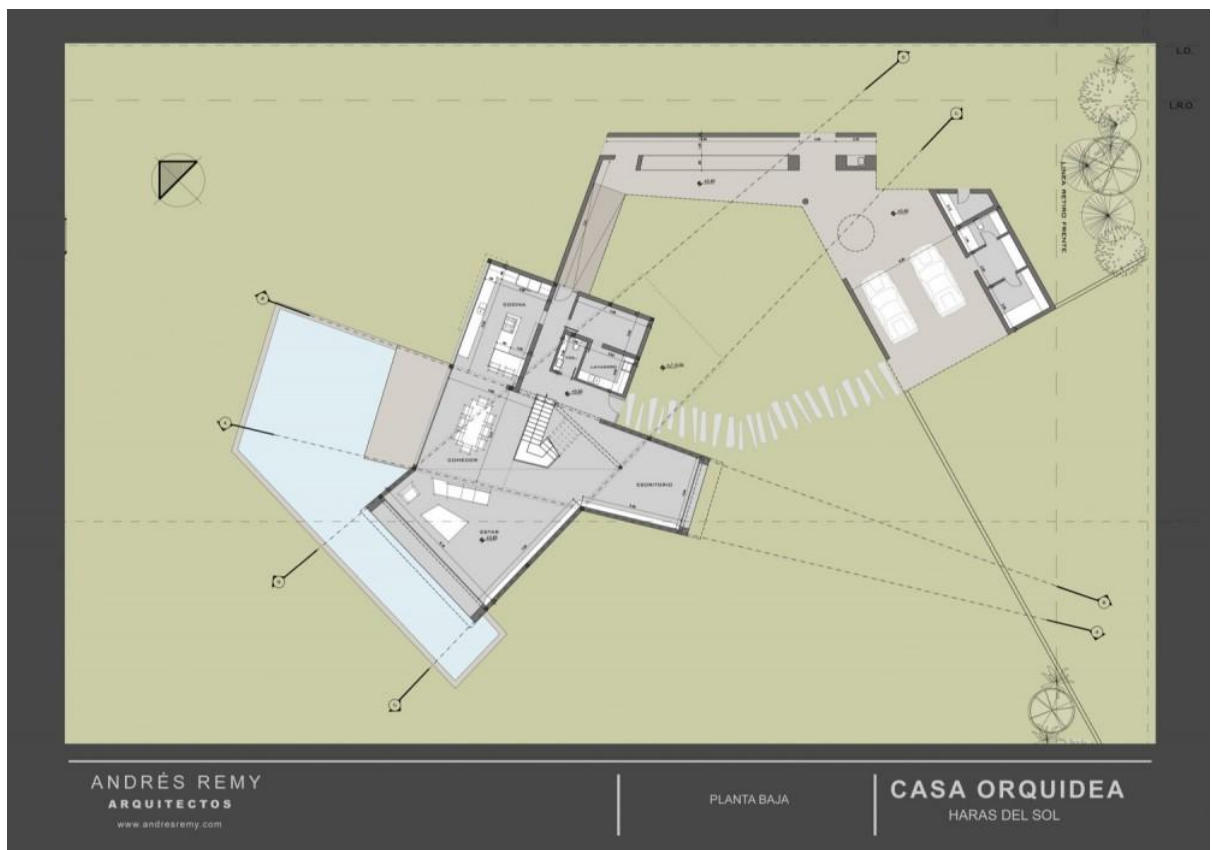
Planta baixa - Pavimento Térreo. Casa Orquidea - Andrés Remy. (Fonte: ANDRES REMY ARQUITECTOS, 2010)
